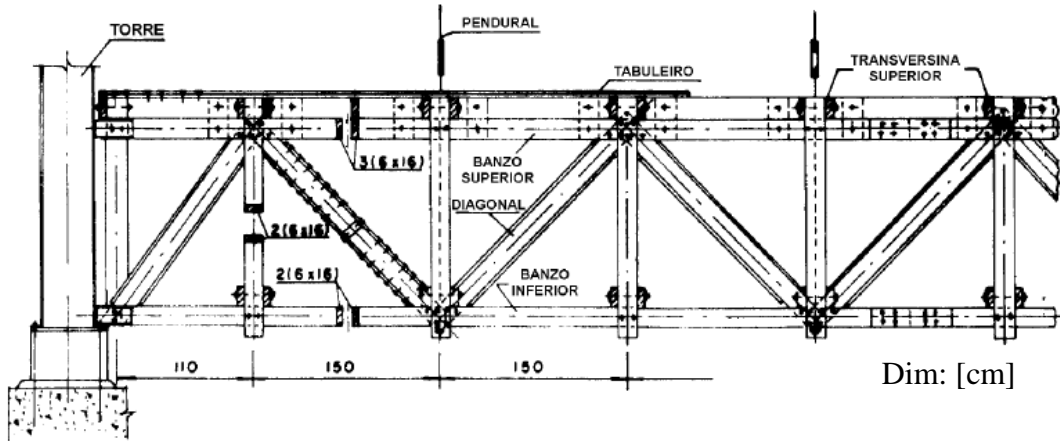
Elevação lateral (Revista Madeira, 2001)
